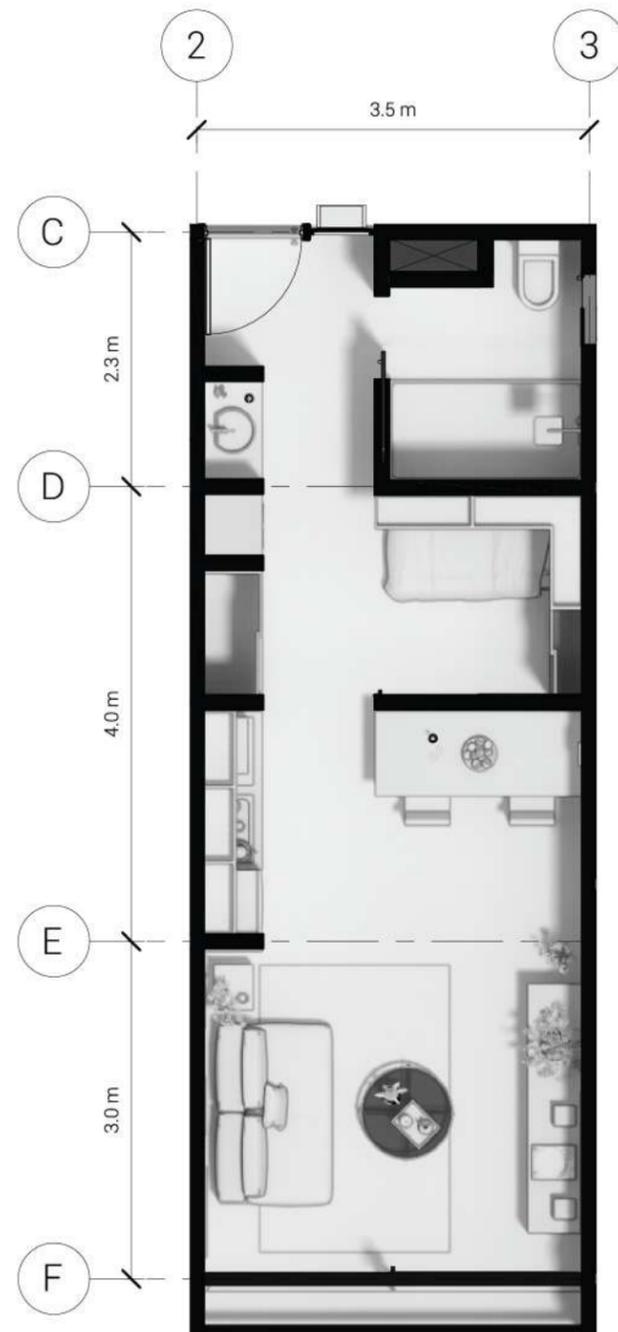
Planta de distribución de apartamento individual. Fuente: propia.
